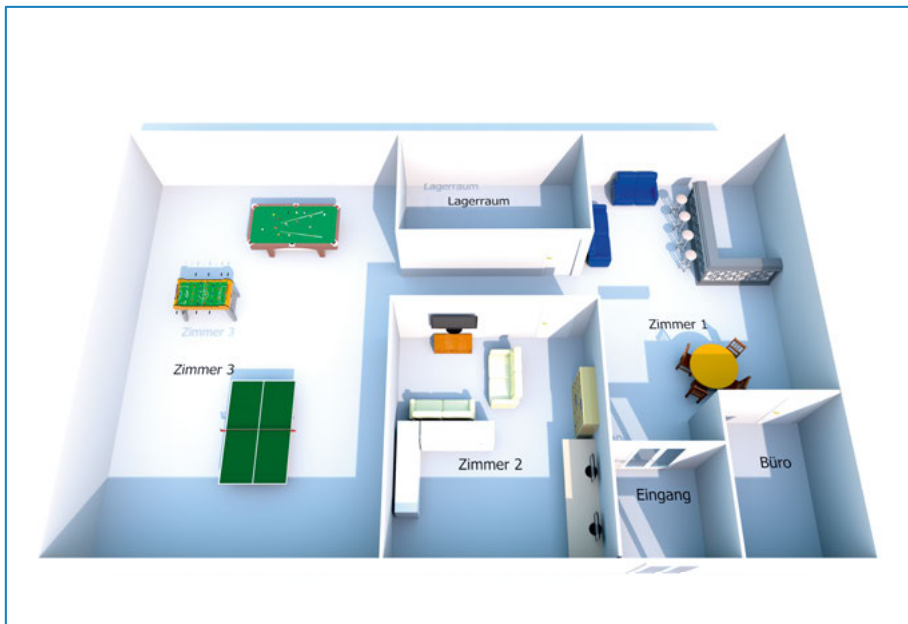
Grundriss des Kinder- und Jugendzentrums
